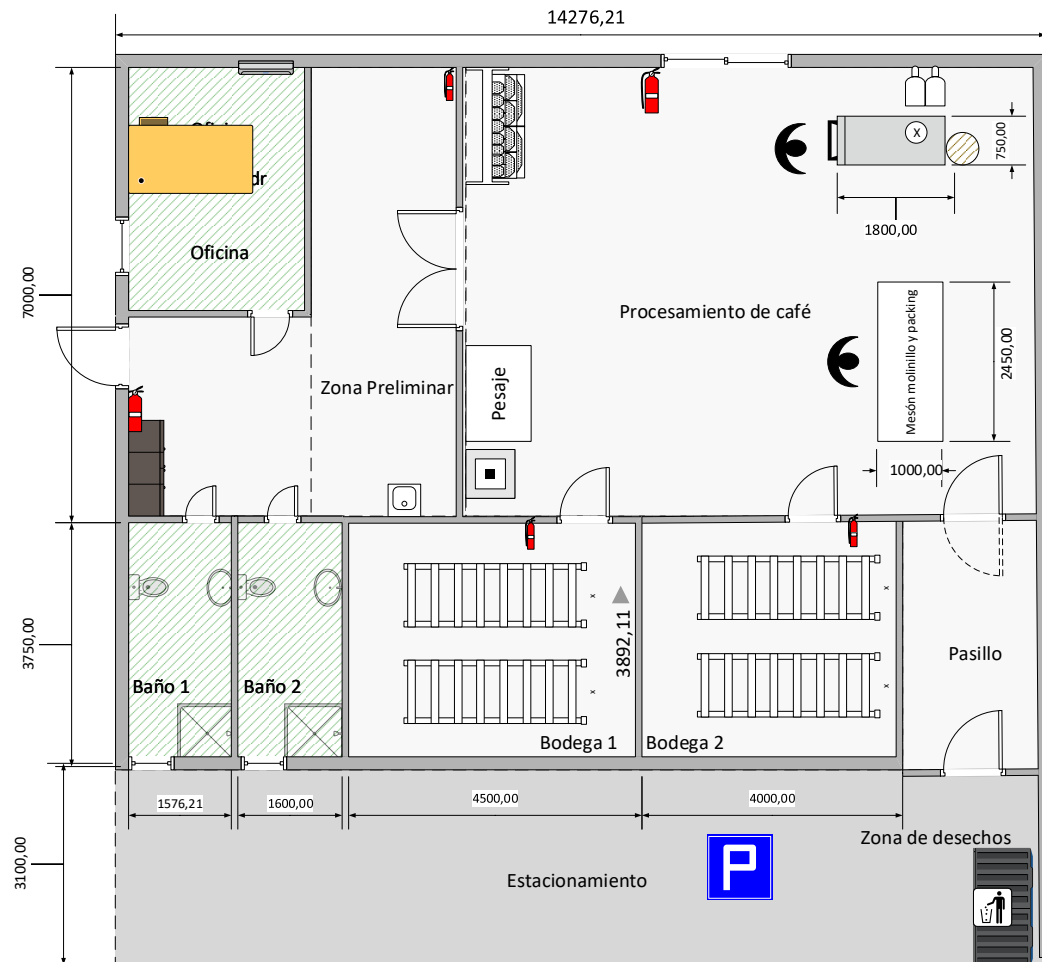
Plano de planta sin proyecto. Elaboración propia.
